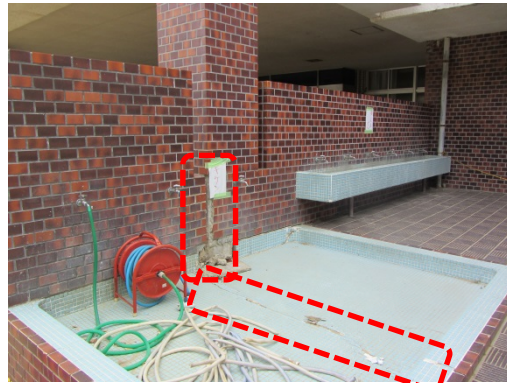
小学校の昇降口付近のひび割れ（足洗い場）
